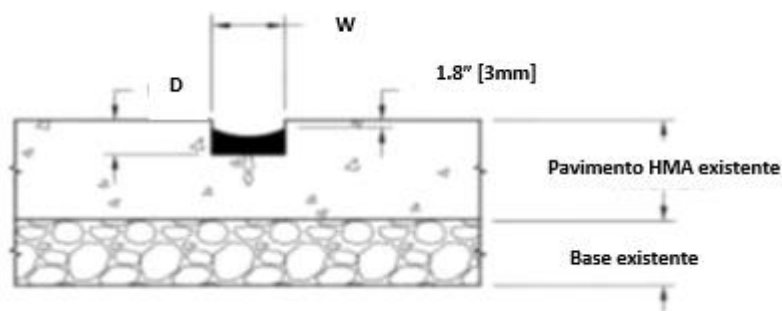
Croquis de reparación de fisuras para pavimentos flexibles. (Recuperado de [25]).
